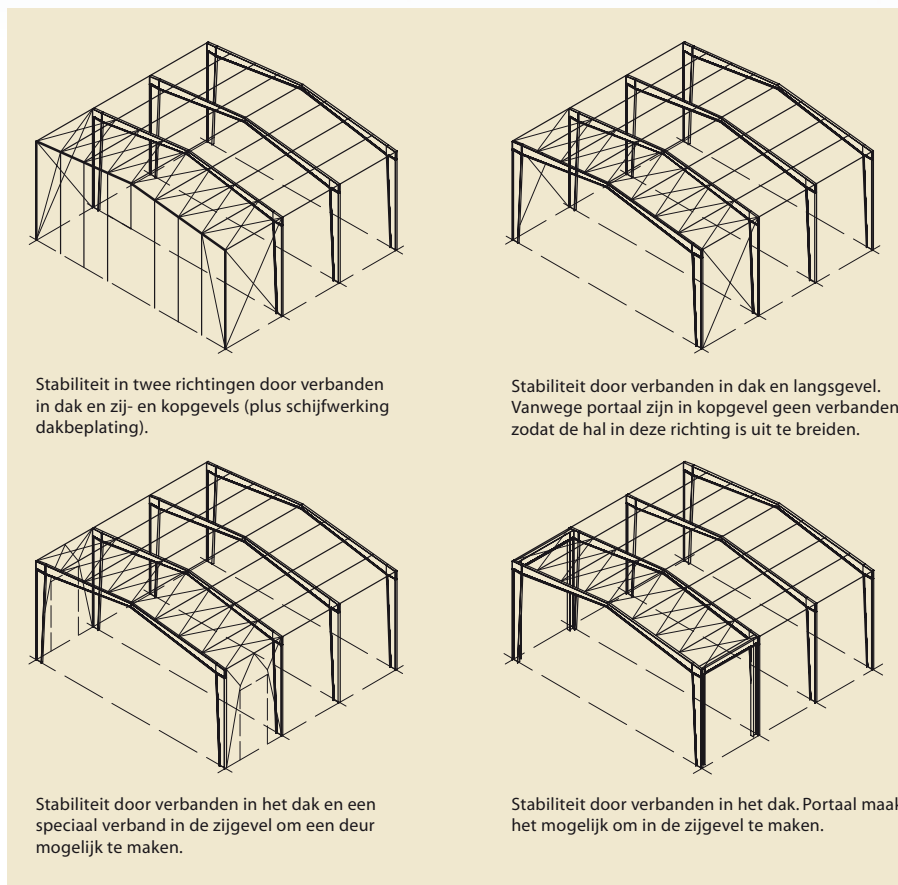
Mogelijkheden om portaalconstructies loodrecht op zijn vlak te stabiliseren.
